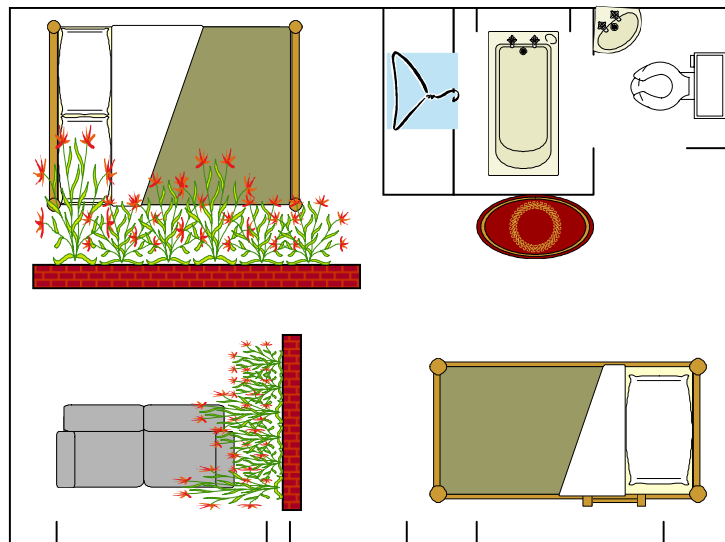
Bosquejo del modelo propuesto para las cabañas a construir
